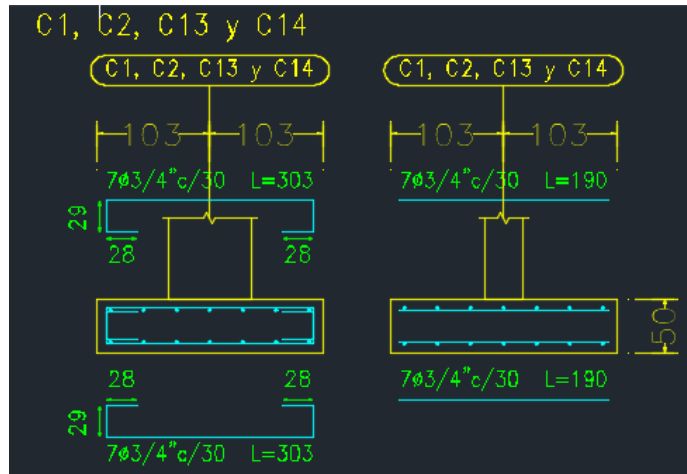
Vista en planta Zapata tipo I. Fuente planos estructurales
